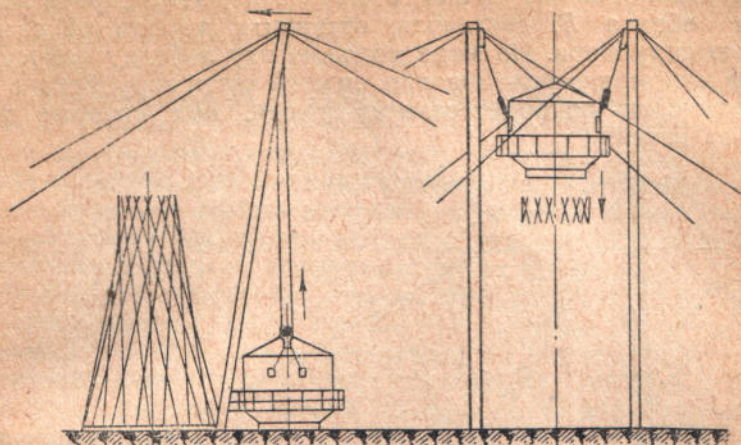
Типовая схема подъема резервуаров башни Шухова
